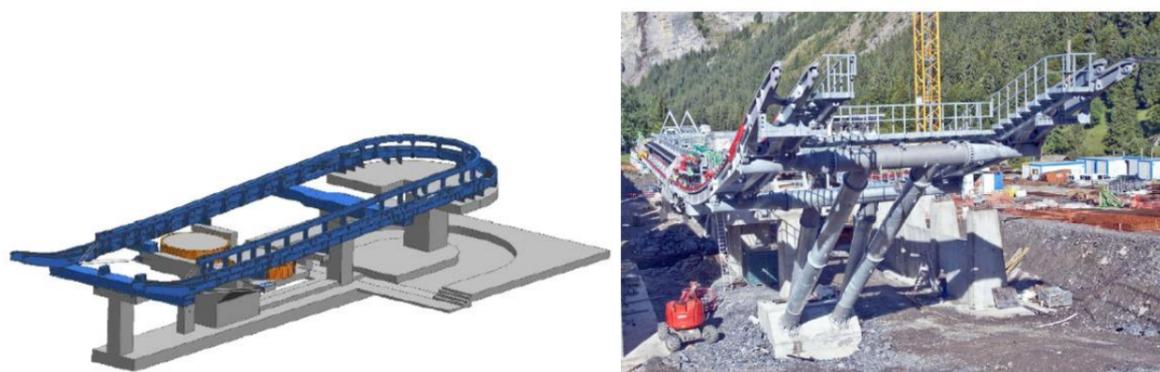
mise en place de la structure centrale (source : Groupement POMA, 2016)
